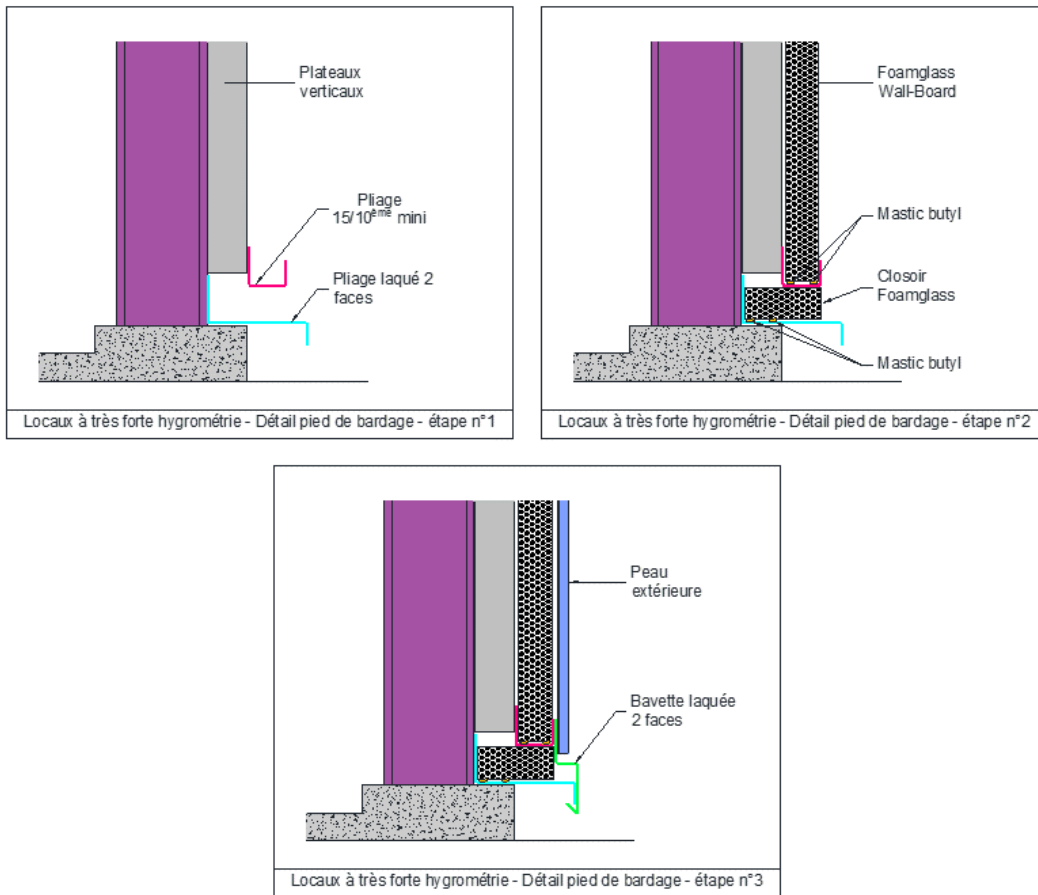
Coupe sur bardage double peau en partie basse (plateaux verticaux)
